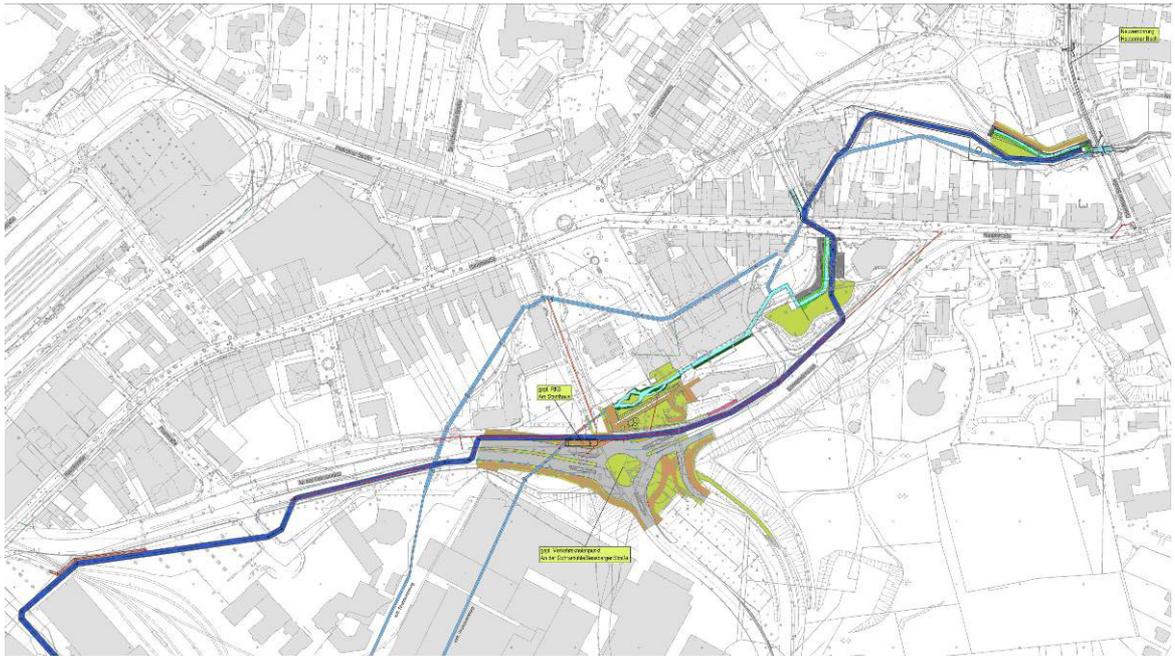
Übersichtslageplan Hochwasserschutz und Offenlegung der Strunde, Stand 07-2014
